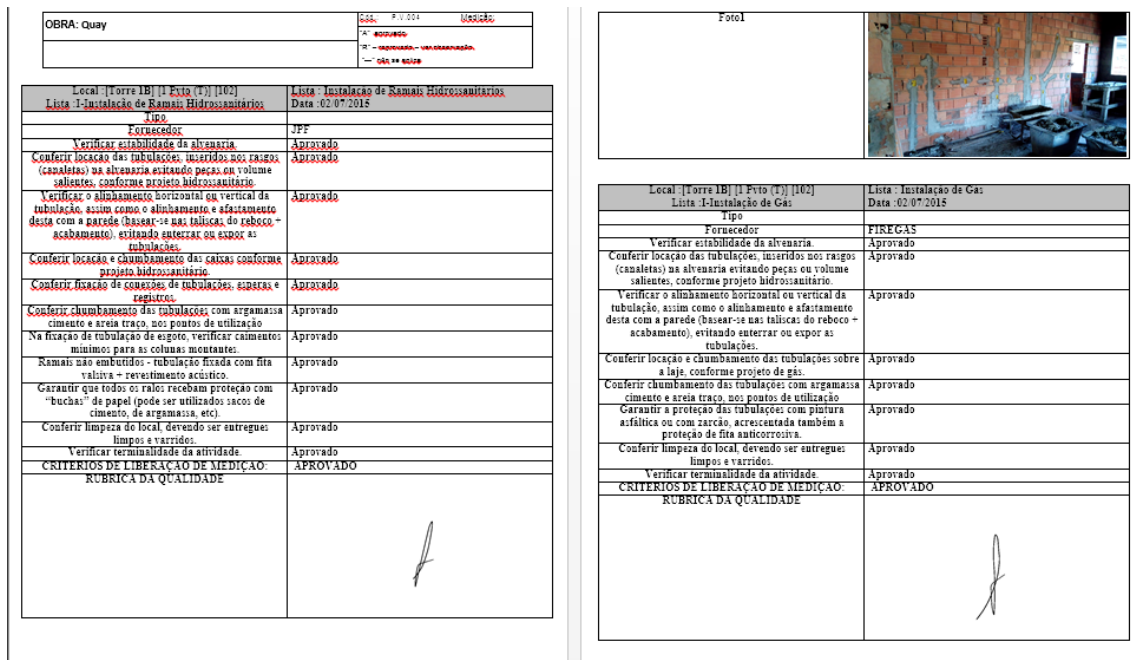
Layout 1 em formato PDF. Fonte: Autor.
